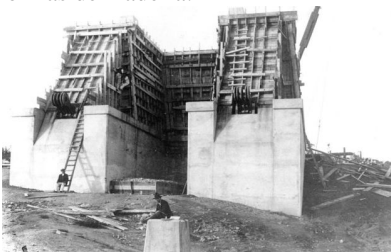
a – Fábrica de cimento em São Paulo e b – Barricas de cimento, lateral esquerda da foto.
